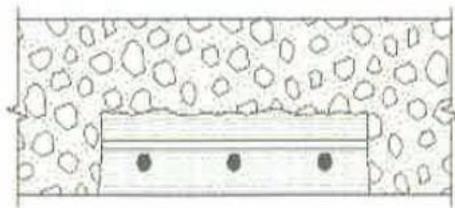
Espaçamento entre armadura e concreto para reabilitação.
